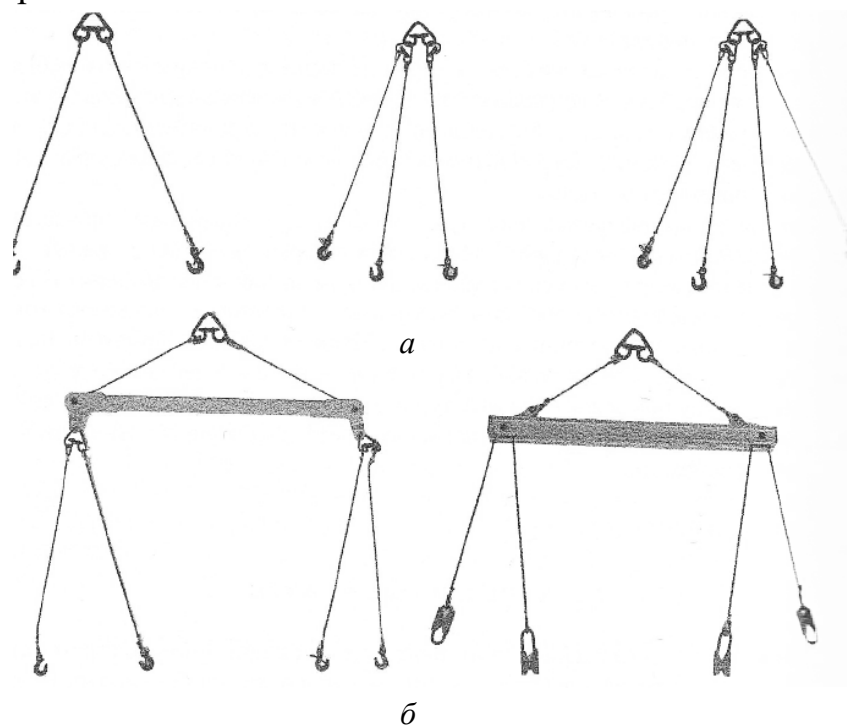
Приспособления для строповки арматуры, арматурных сеток и каркасов: *а* – многоветвевые стропы; *б* – балансирные траверсы
